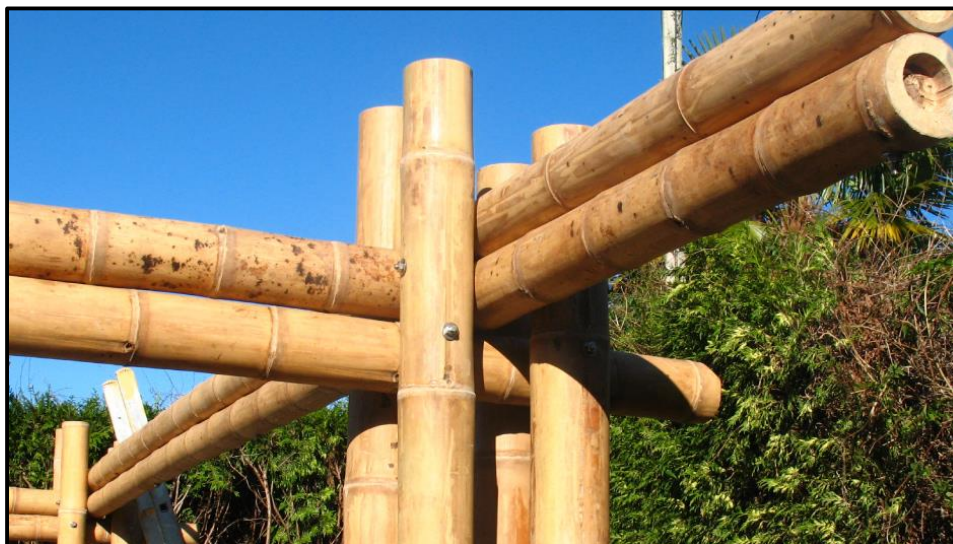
Columna y vigas de bambú unidas por medio de varillas enroscadas, tuercas y arandelas en la construcción de una vivienda en Valencia. *Fuente: Bambusa (2014).
